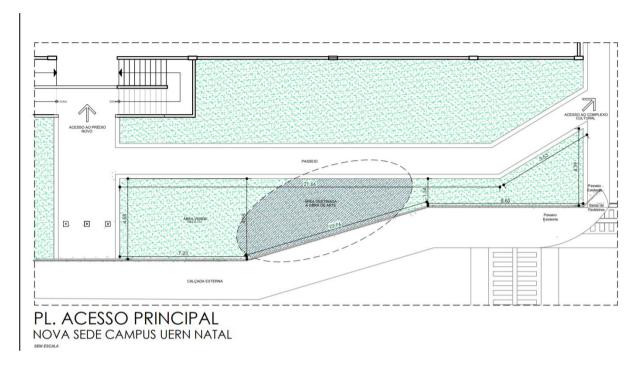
Planta com destaque na área para instalação da obra de arte
